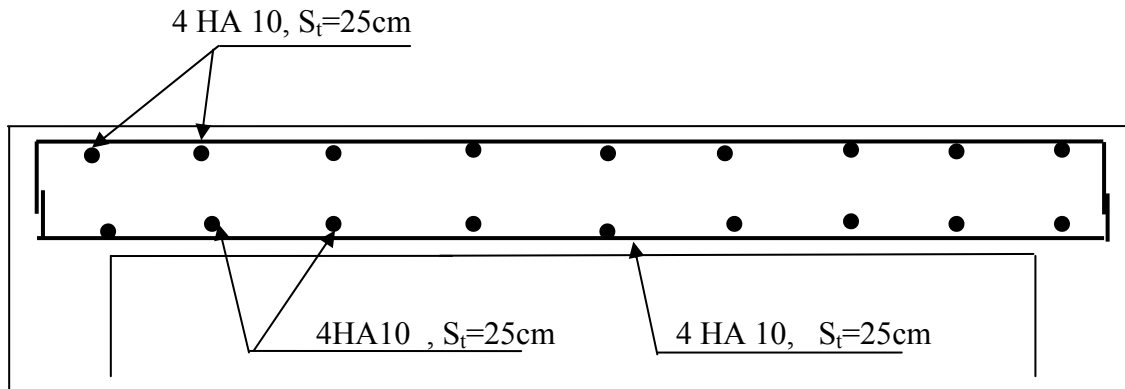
Plan de ferrailage de la salle machine suivant x-x.
